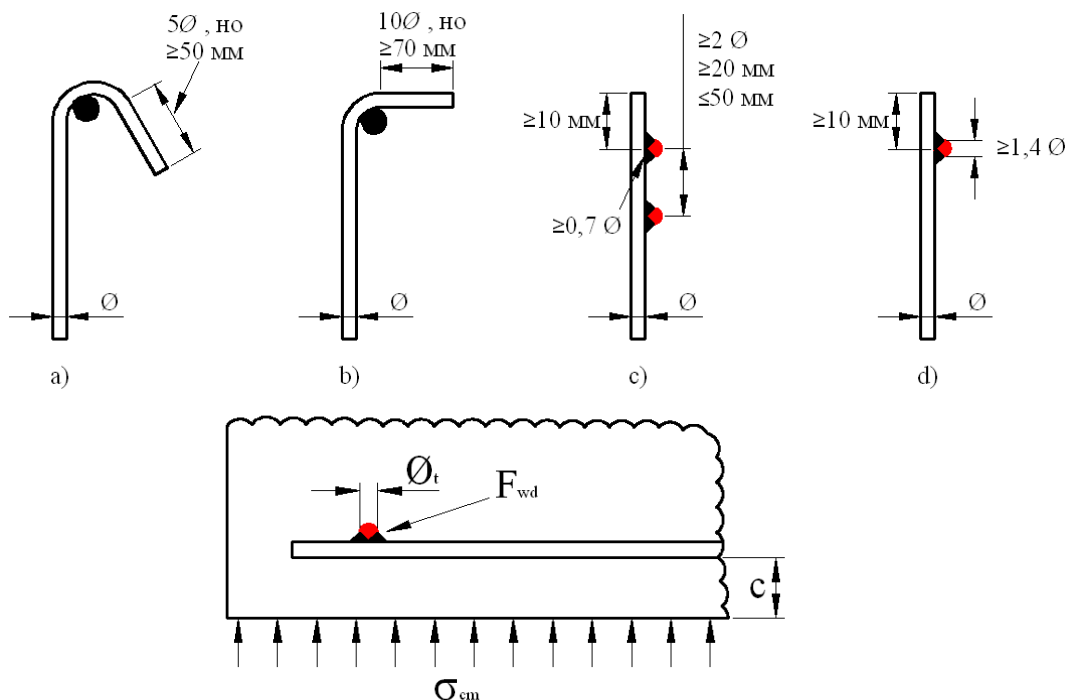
Приваренный поперечный стержень как анкерное устройство
